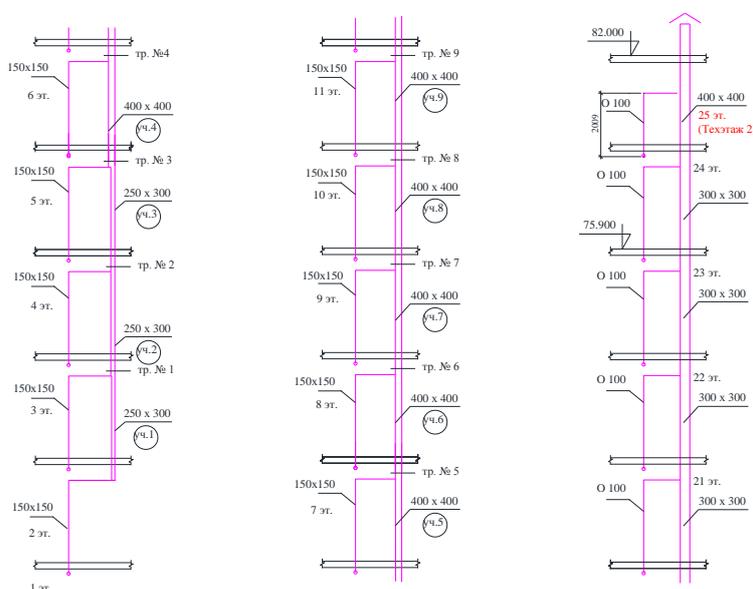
Фрагмент расчётного вентиляционного стояка естественной системы
